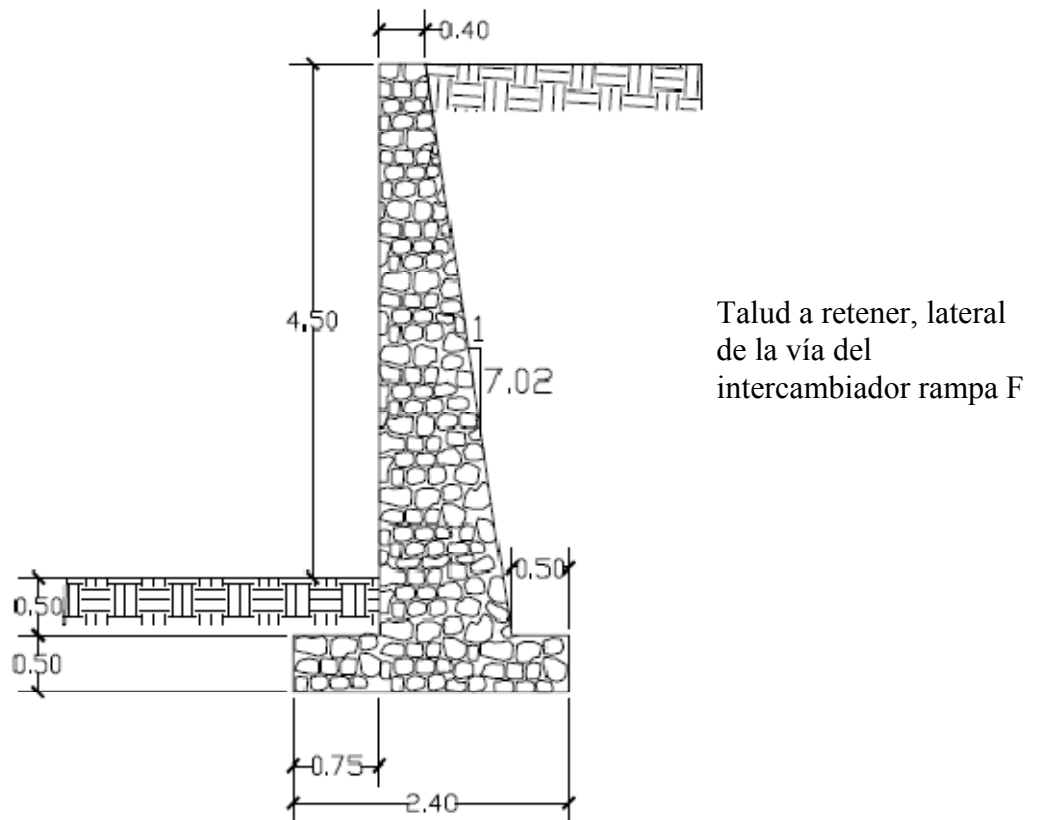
20 Detalle de muro equivalente de gravedad hecho de mampostería de piedra.
